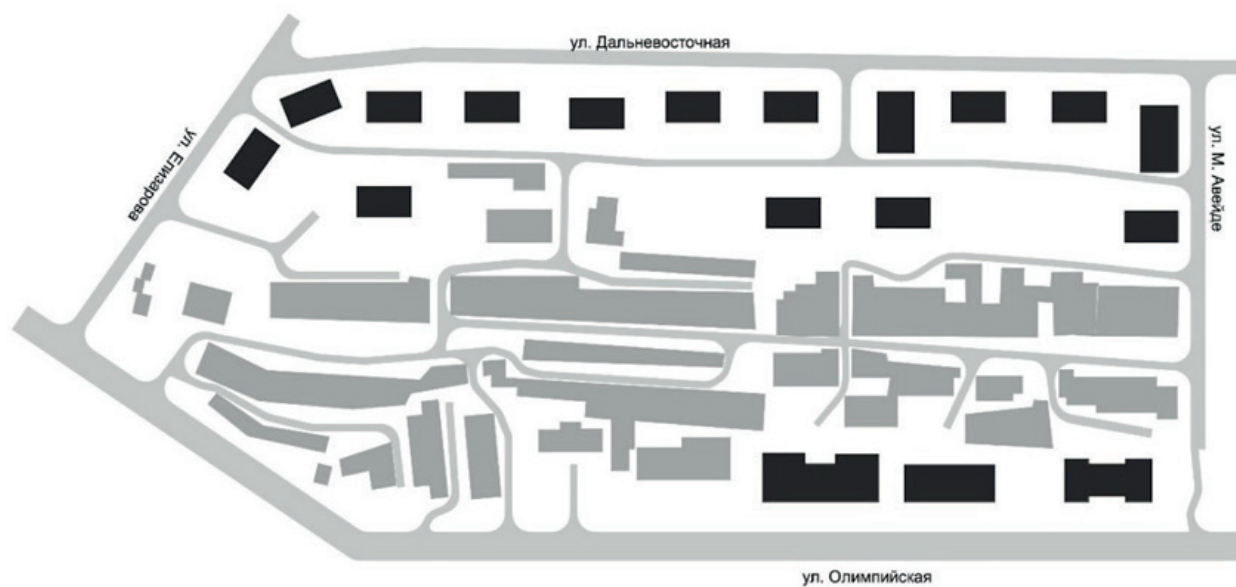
Архитектурные формы типовых малоэтажных зданий Самары
